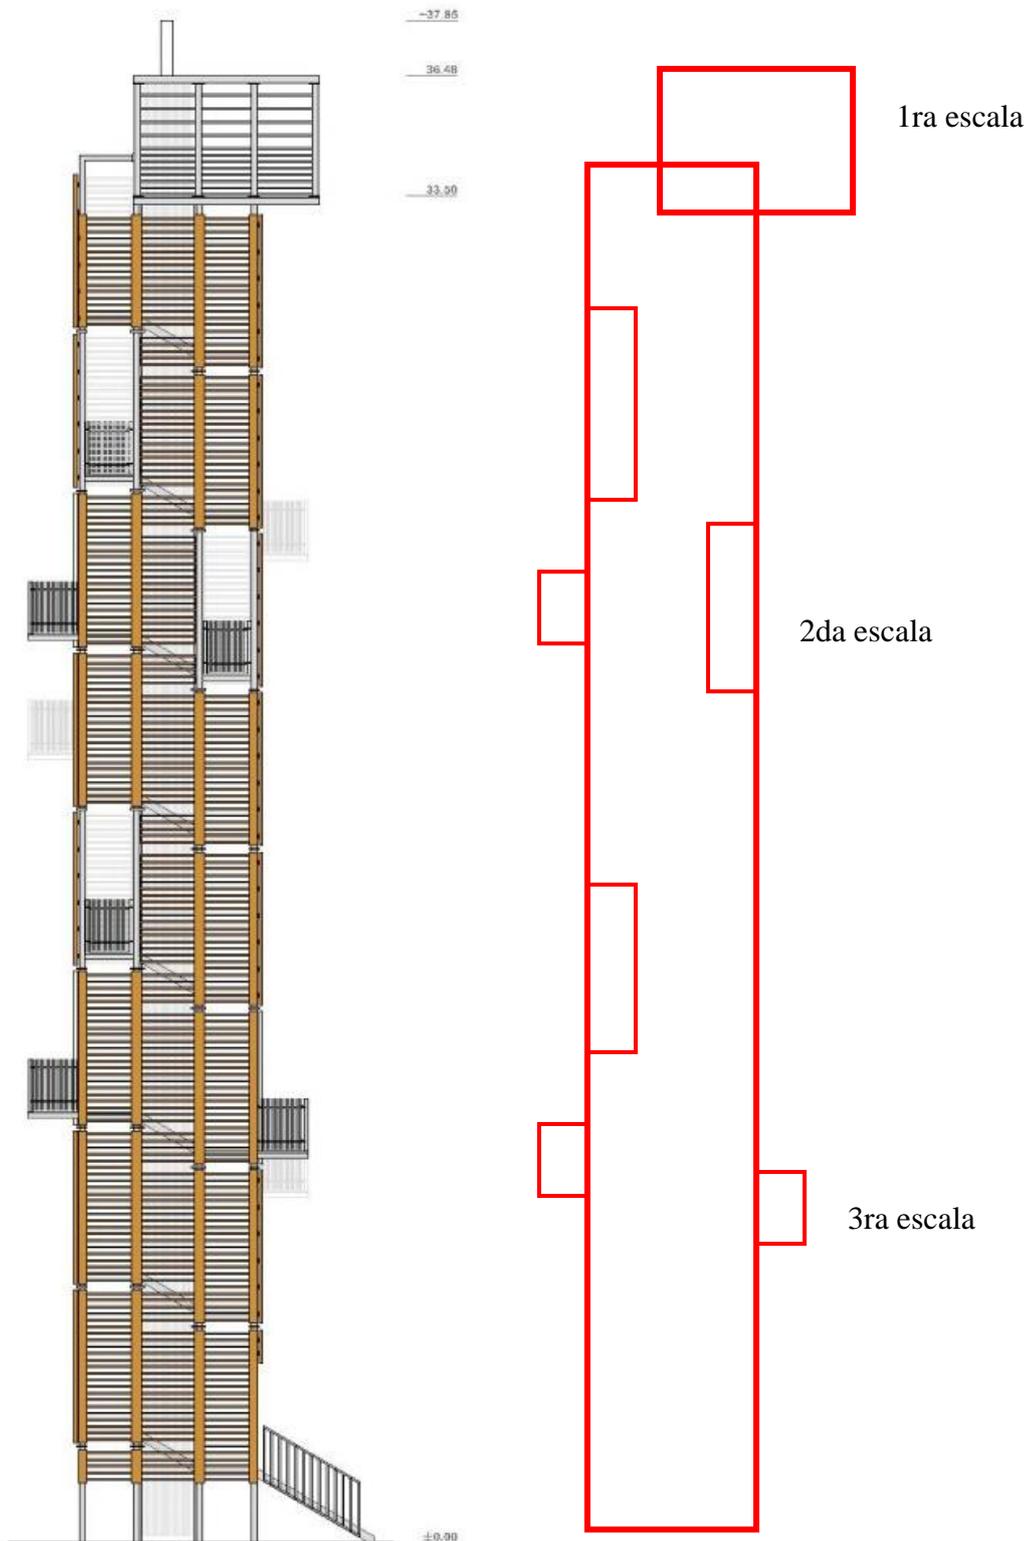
y diagrama 51: Planimetría corte. Elaboración propia del autor.
